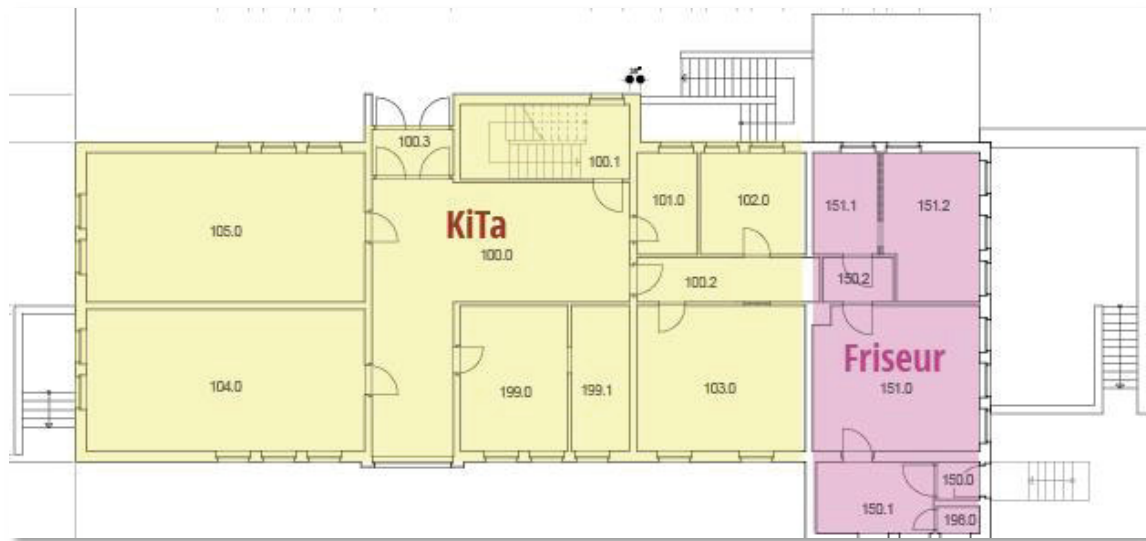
Grundriss Erdgeschoss, KiTa „Glückskäfer“ mit Kennzeichnung Nutzungsbereiche
